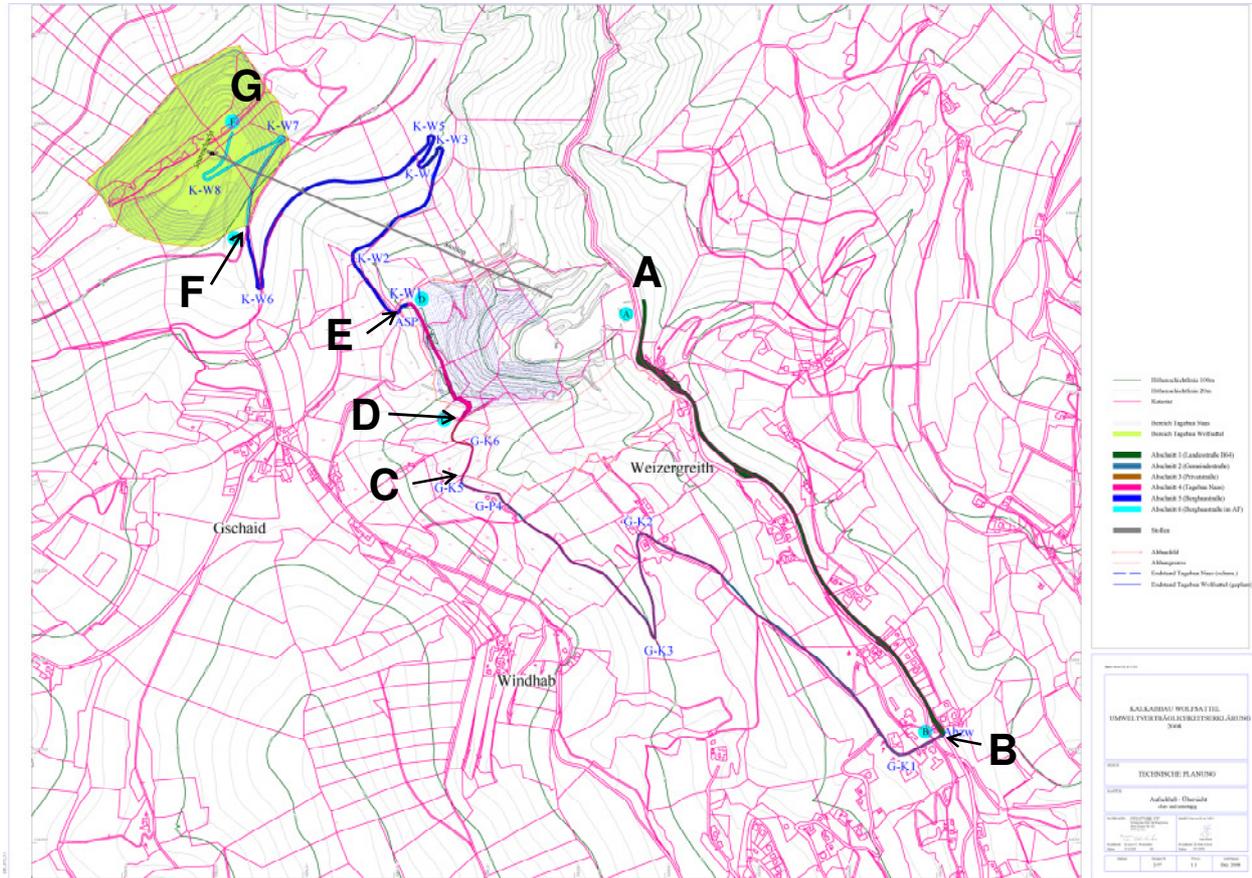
Übersichtsplan des Zufahrtsweges und dem Teilabschnitt der Bergbaustraße
